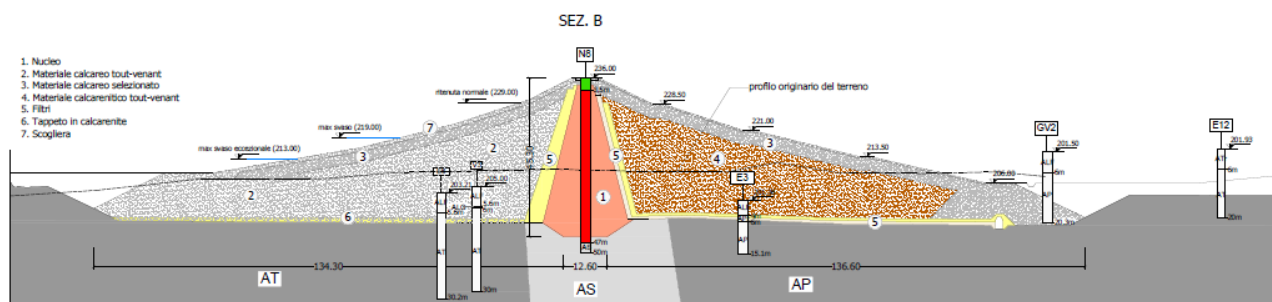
Sezione trasversale della diga B da progetto esecutivo con sovrapposizione del sondaggio N8 eseguito nella campagna d'indagine 2021.
